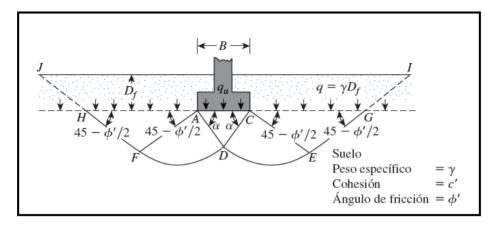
Falla por Capacidad de Carga en un Suelo Bajo una Cimentación Rígida continua
